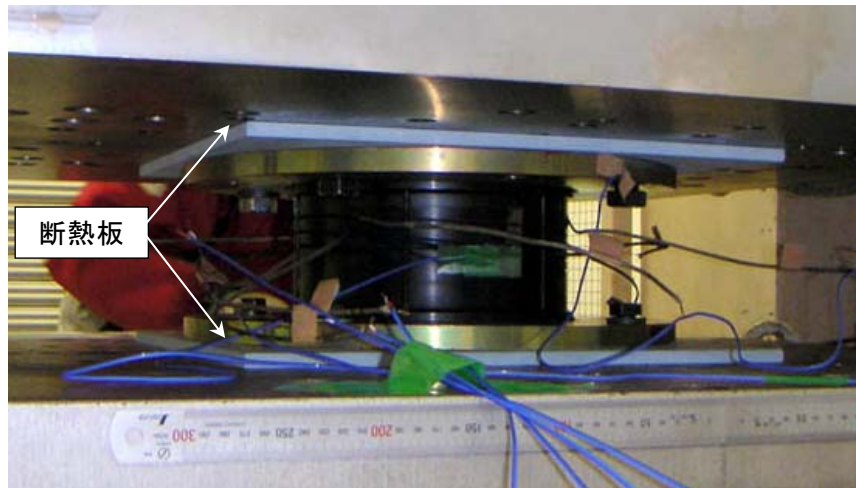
積層ゴムの試験状況 1.2-1)
